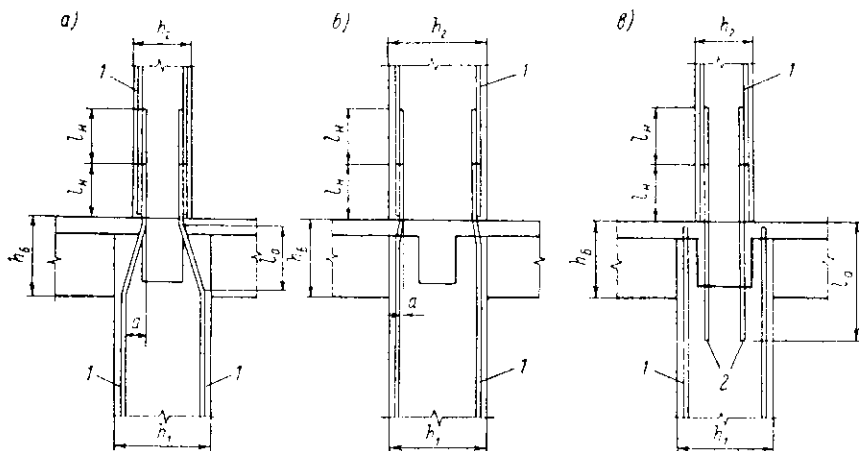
Стыки продольной арматуры монолитных колонн многоэтажного здания
